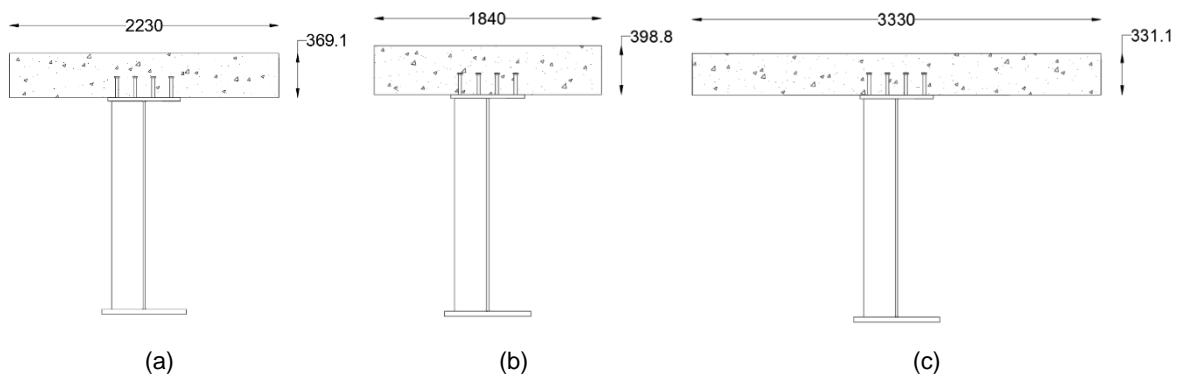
Seções em análise: (a) secção S1, (b) secção S2 e (c) secção S3 [dimensões em mm]
